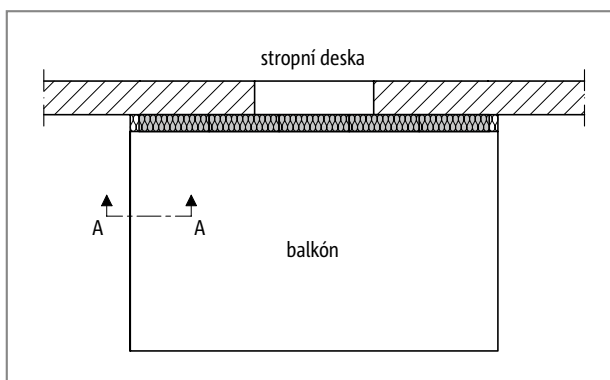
Schöck Isokorb® CXT typ KL: Napojovací stavební výtuž u nepřímého uložení
